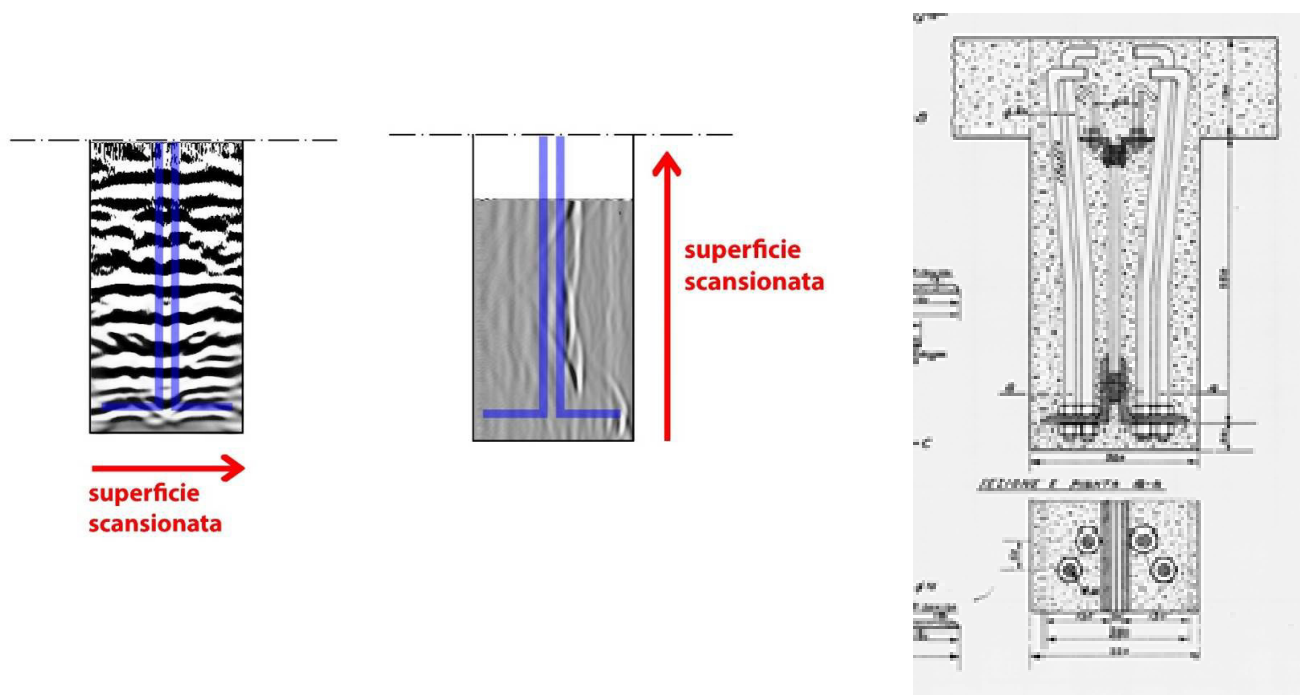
Sezione verticale trasversale – ipotesi ricostruttive e disegno di progetto
